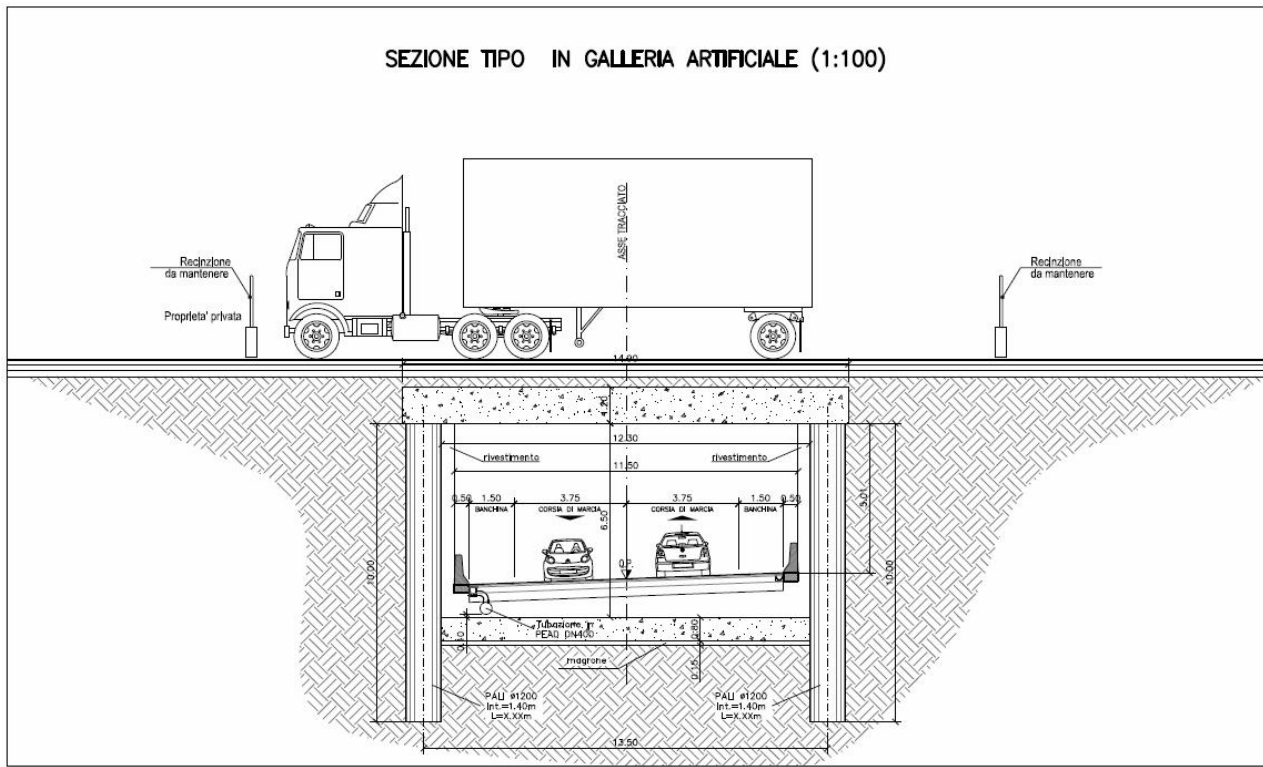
Sezione tipo - Galleria artificiale S.P.n.101
